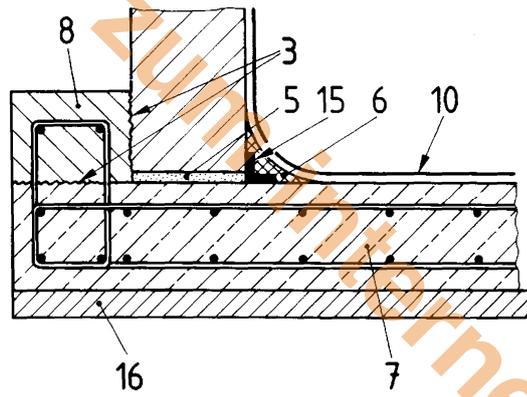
Behälterwand aus Betonschalungs- bzw. Betonformsteinen (nur für Hochbehälter)
